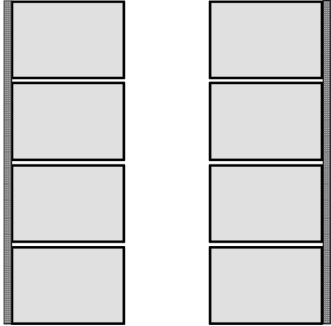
bis 3: Grundrissformen zur Bestimmung der Höchstwerte für Fassaden nach Tabelle 12
